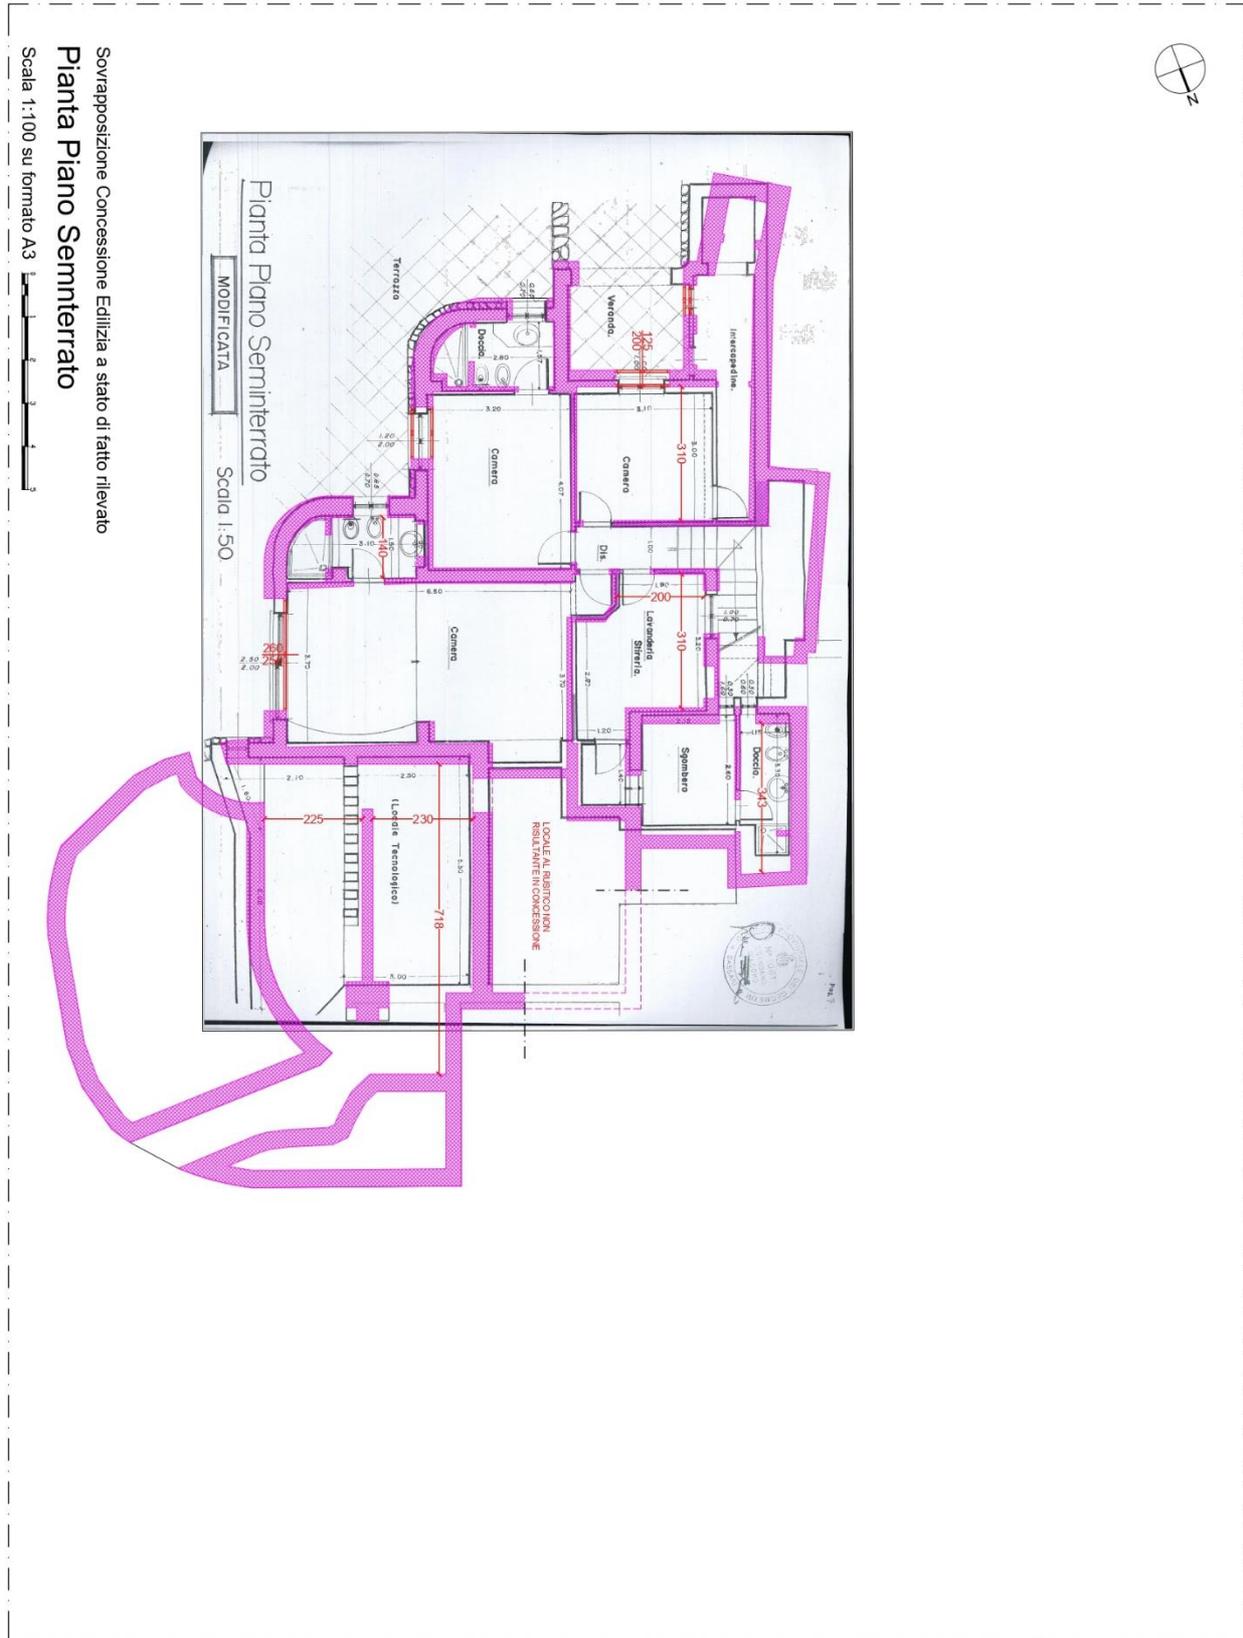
Planimetria piano seminterrato - Sovrapposizione stato di fatto rilevato a progetto approvato. In viola sono indicate le murature così come rilevate, in rosso le quote risultate allo stato di fatto difformi da quelle indicate nel progetto approvato; sono state inoltre evidenziate in rosso le finestre difformi o per posizione o per dimensione dal progetto approvato
